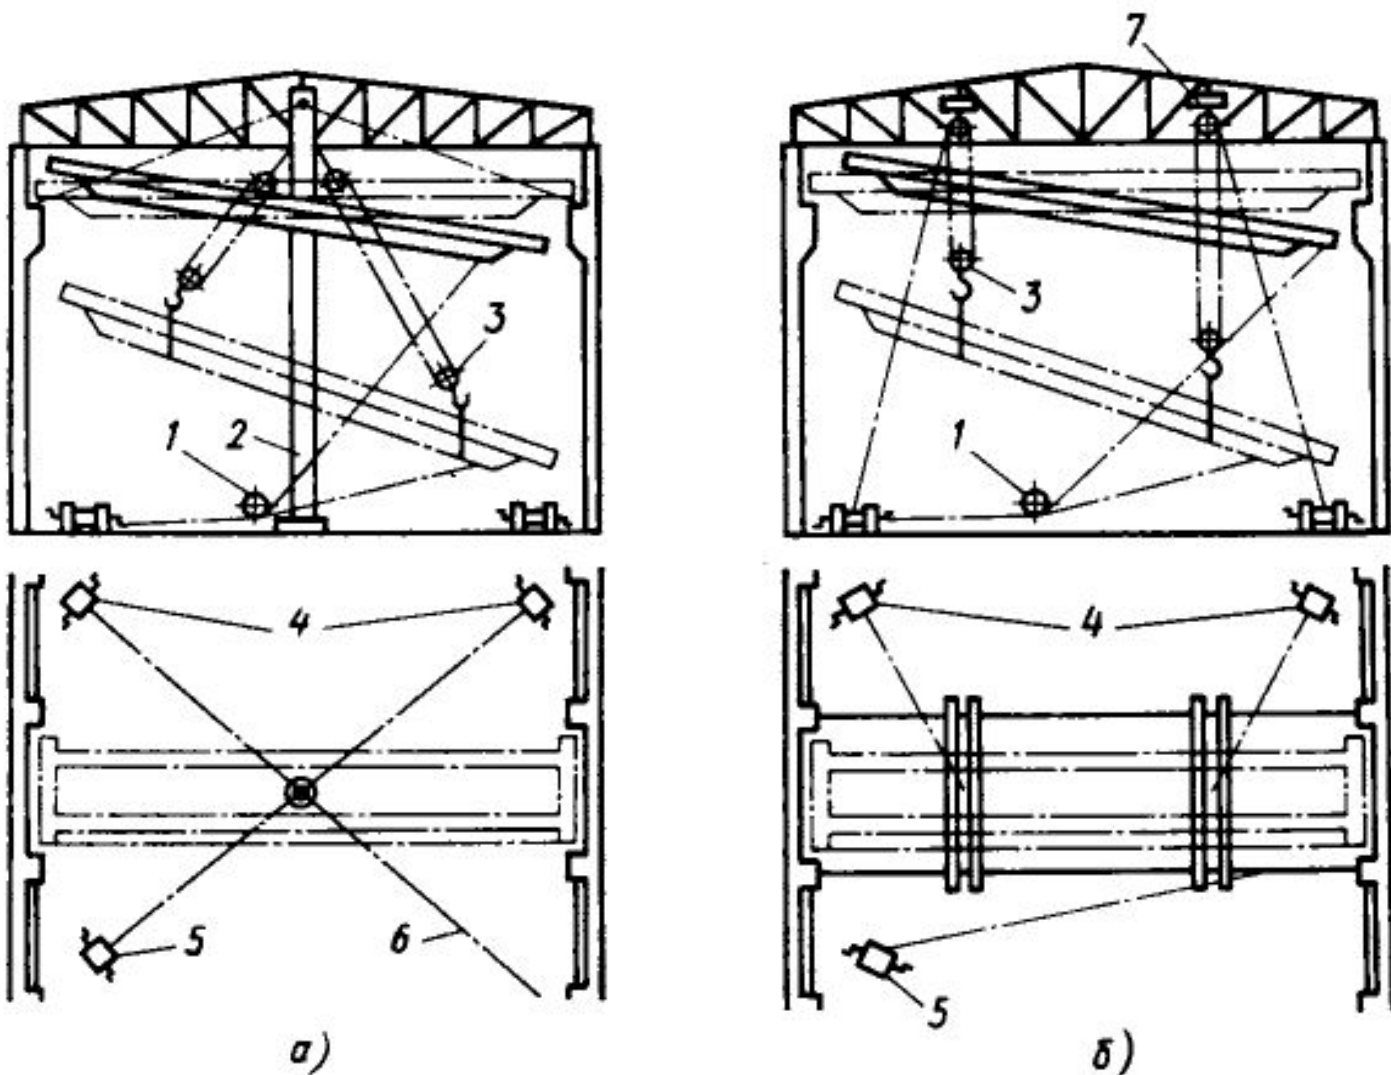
Схема подъема моста в наклонном положении «рыбкой»: а – монтажной мачтой, б – двумя монтажными балками: 1 – отводной блок, 2 – мачта, 3 – полиспаст, 4 – подъемная лебедка, 5 – лебедка смещения моста, 6 – расчалка, 7 – монтажная балка
